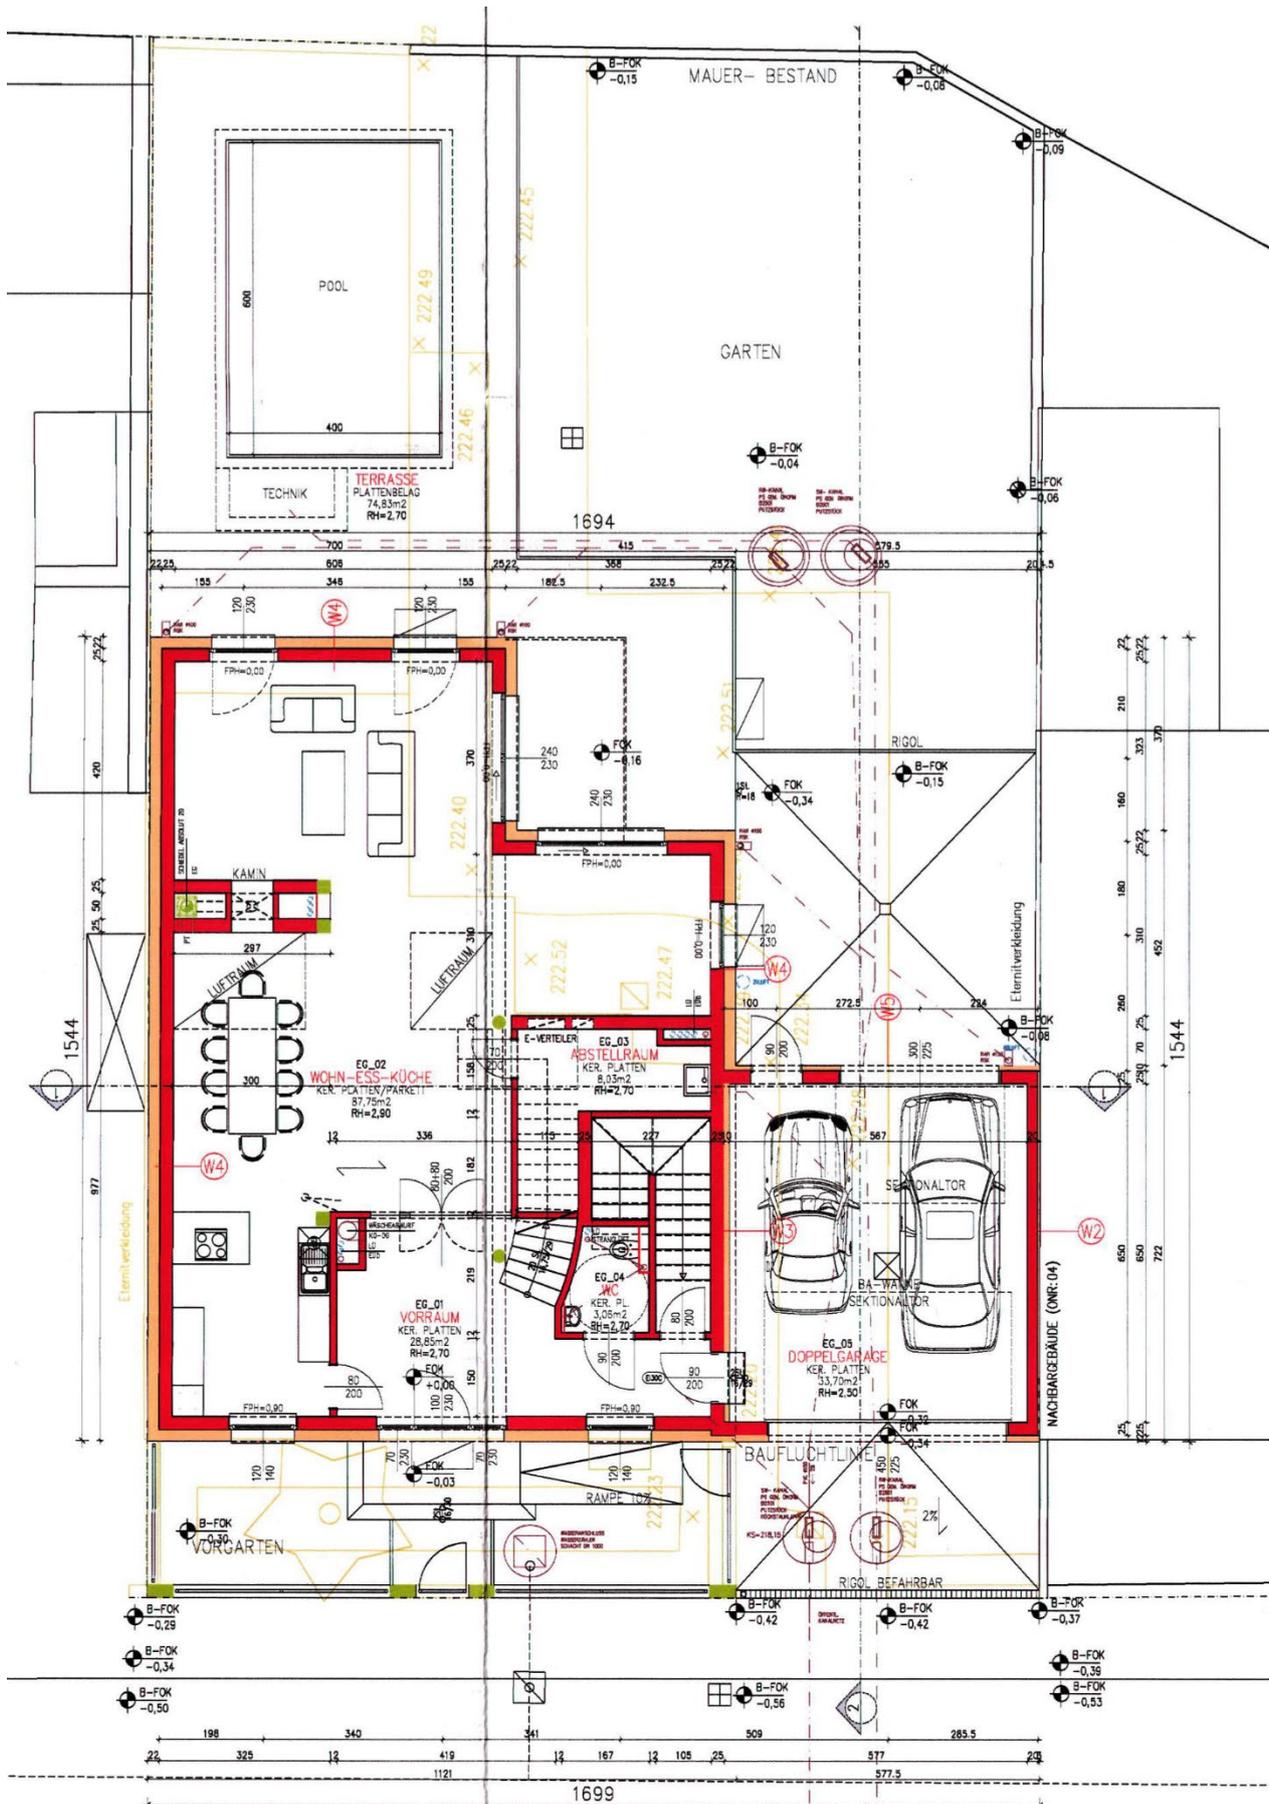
Grundriss Erdgeschoss | Einreichplan | Pongratz Bau GmbH (gezeichnet von Dipl.-Ing. Gassenbauer) | 01.04.2010
